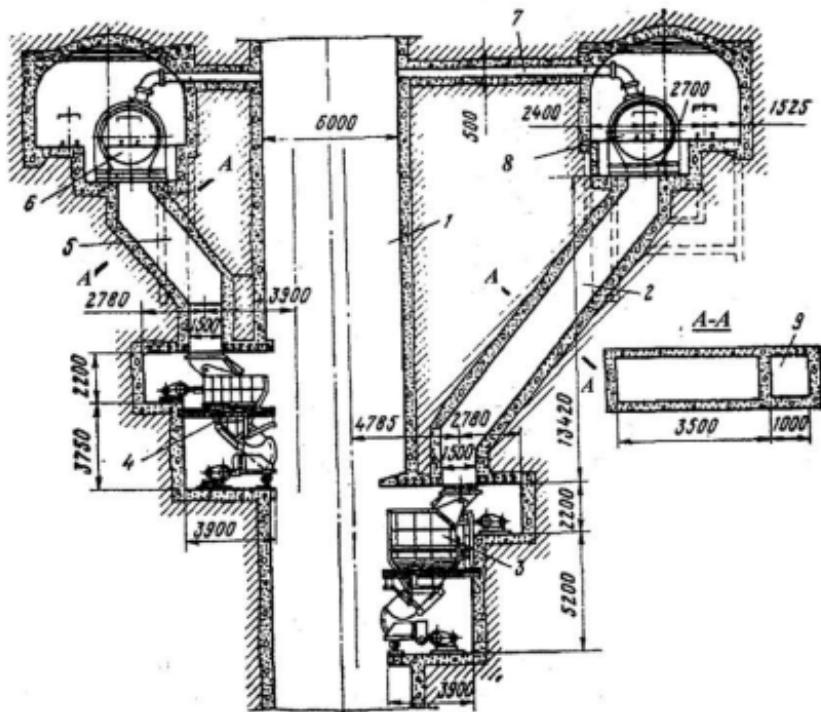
Комплекс камер загрузочного устройства скипового подъема:
